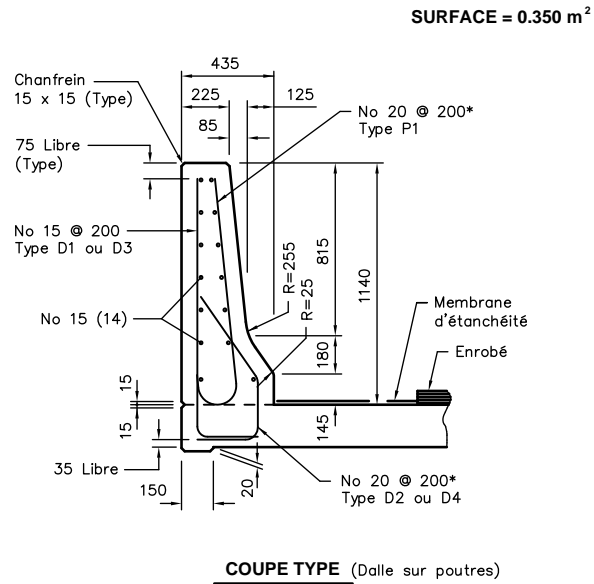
Glissière en béton type 211B (sur trottoir non séparé de la chaussée)
